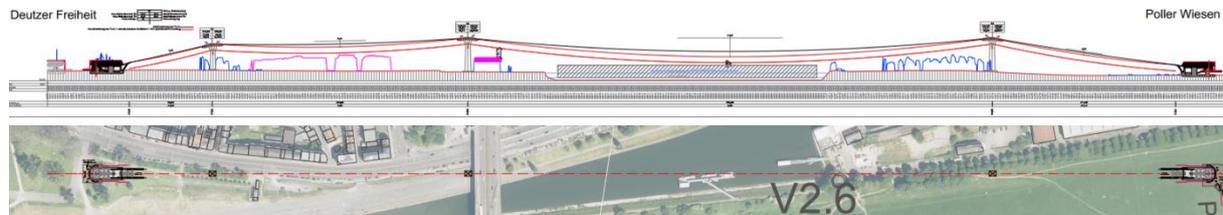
Längenschnitt, Lageplan Variante V2.6
